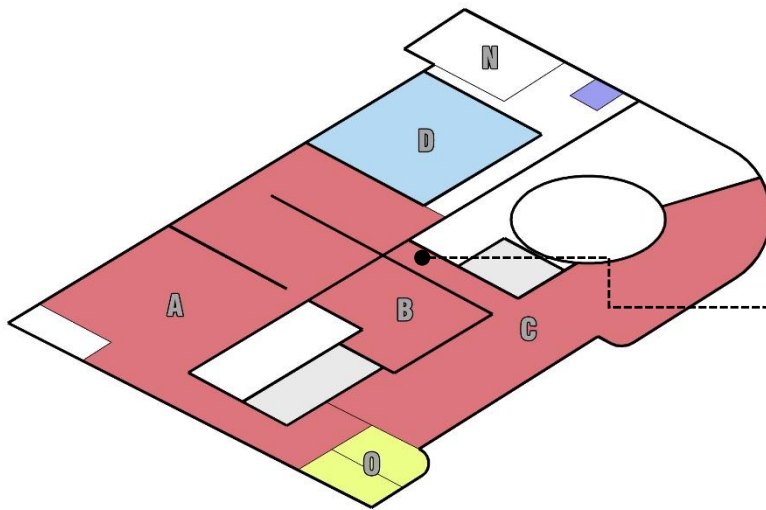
imagen distribución – planta 2 teatro lux / elaboración propia.
